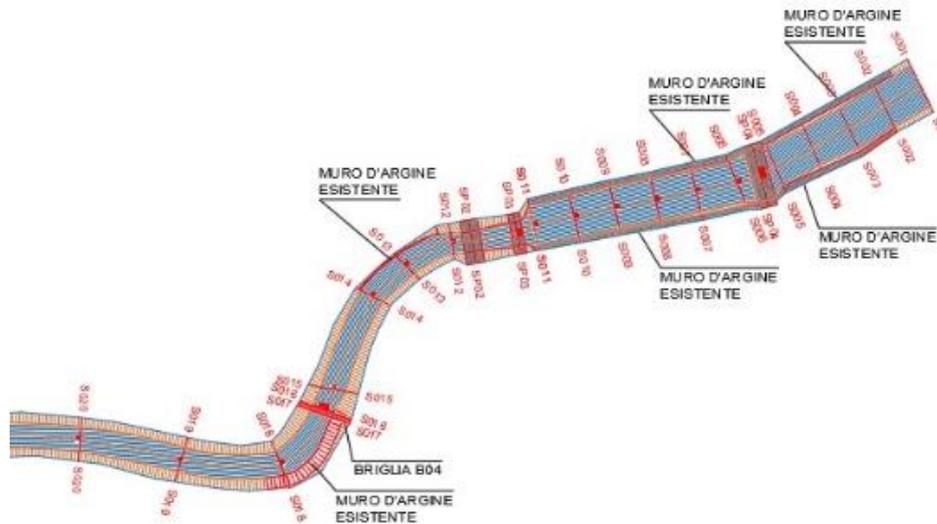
Torrente Borrone – Planimetria con dettaglio n. 1 interventi di progetto
